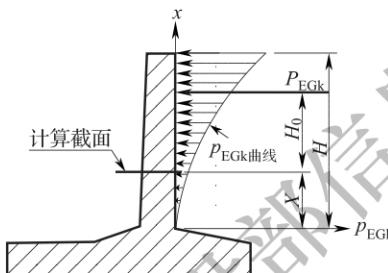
钢筋混凝土防火堤水平地震作用计算示意图
